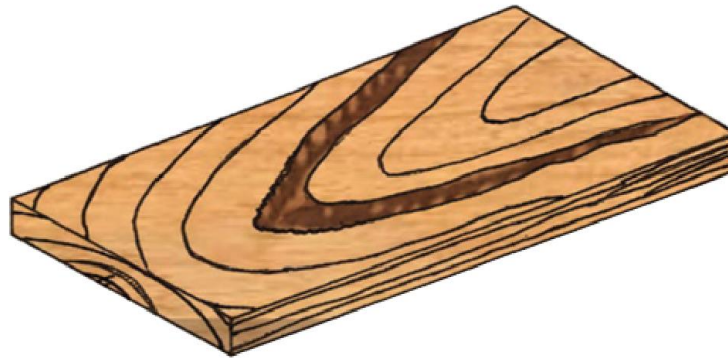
Escamadura, Manual de construcción de vivienda de madera, 2014.
